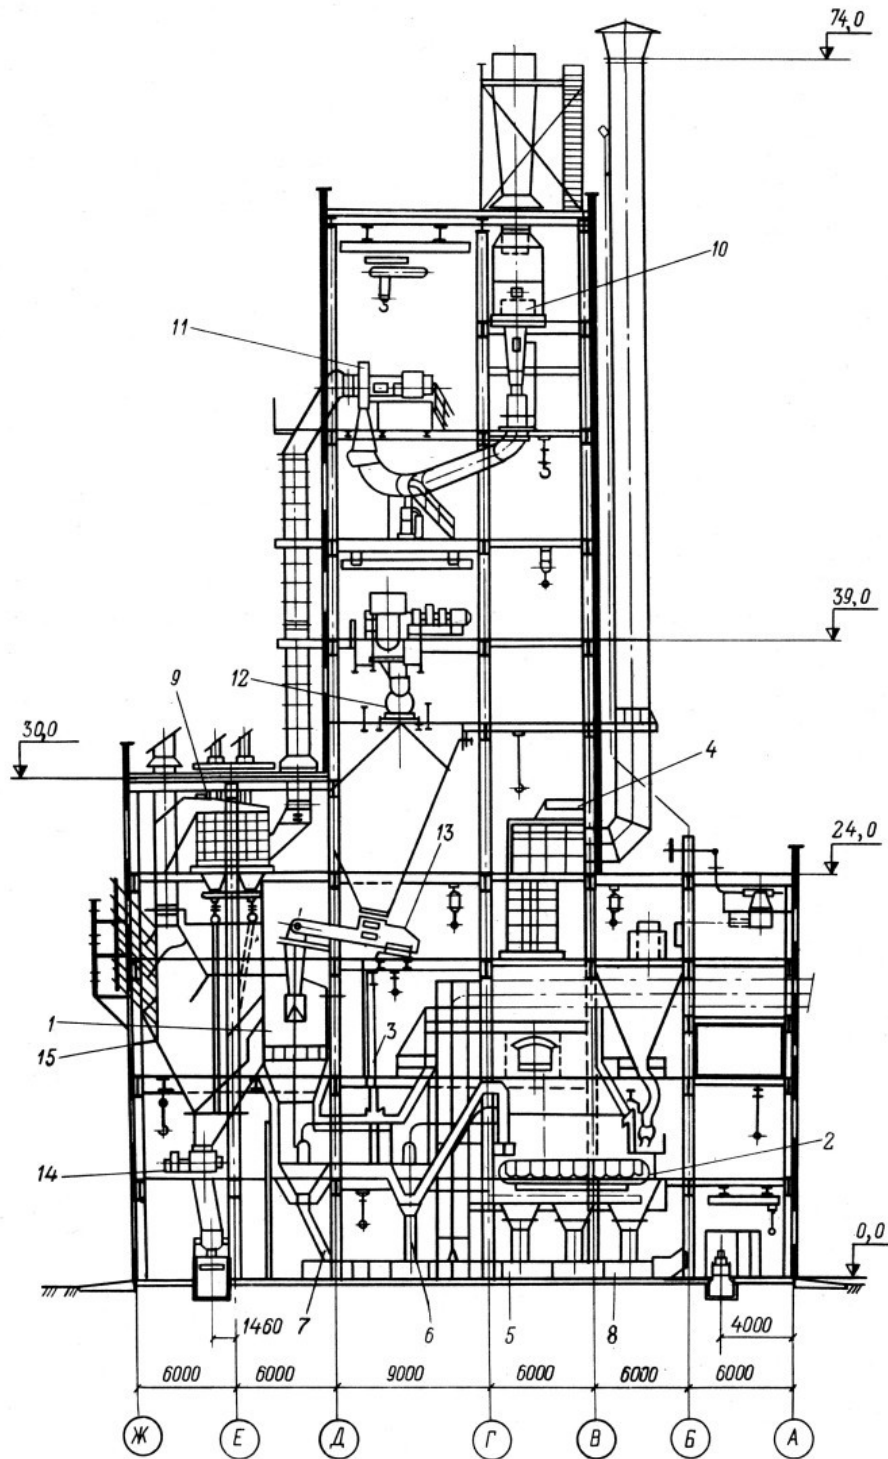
Вертикальный разрез сушильного корпуса ОФ: 1 – сушильный аппарат кипящего слоя с площадью решетки 12 м²; 2 – топка с чешуйчатой цепной решеткой обратного хода ТЧЗМ2, 7–8,0; 3 – шибер сушильного аппарата с приводом ПЧ–2У; 4 – шибер растопочной трубы с приводом ПЧ–2У; 5 – вентилятор первичного дутья ВДН–15; 6 – вентилятор вторичного дутья ВДН–15; 7 – вентилятор острого дутья ВВД–8; 8 – агрегат для гашения и транспортировки шлака АГТШ; 9 – пылеуловитель батарейный циклонный ПБЦ–100; 10 – аппарат мокрого пылеулавливания М ПР–100; 11 – дымосос (вентилятор мельничный) ВМ–20А; 12 – конвейер подвижной распределительный для концентрата; 13 – питатель скребковый ПСБ–35; 14 – питатель скребковый герметизирующий ПСГ–
